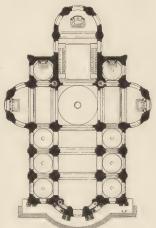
Kathedrale zu Namur. Grundriss.
